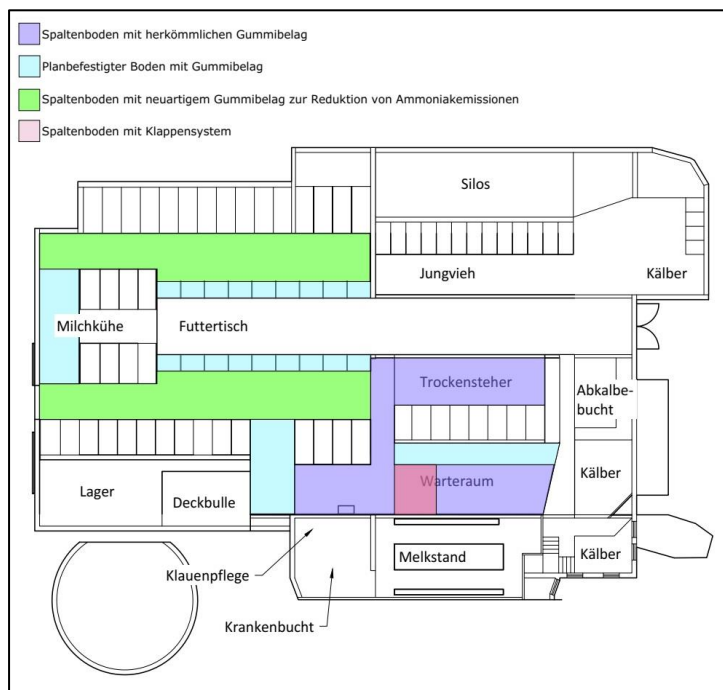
Darstellung der unterschiedlichen Laufgangtypen im Grundriss
